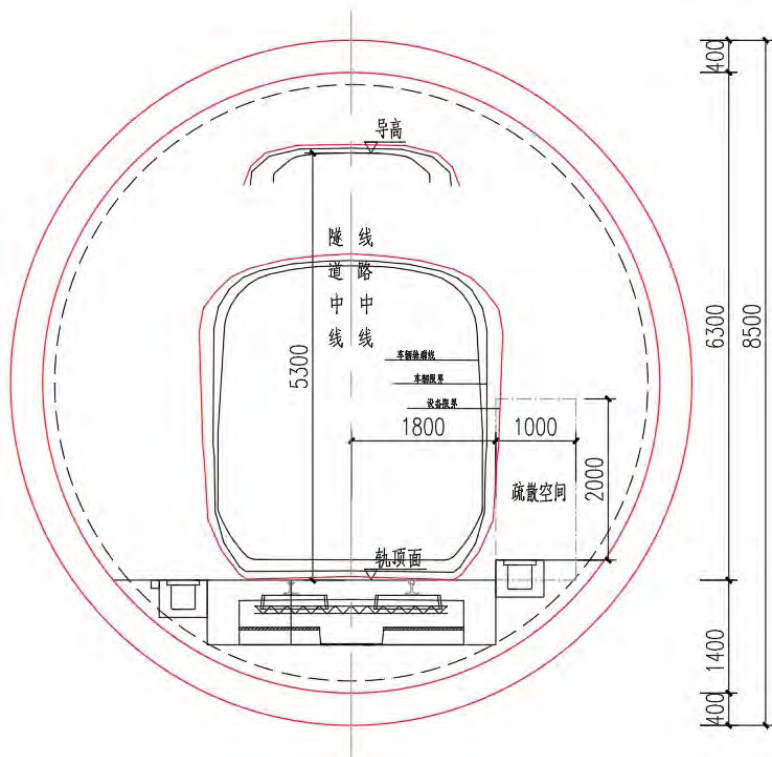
双洞双线盾构法隧道横断面图布置图（Φ8.5m）
